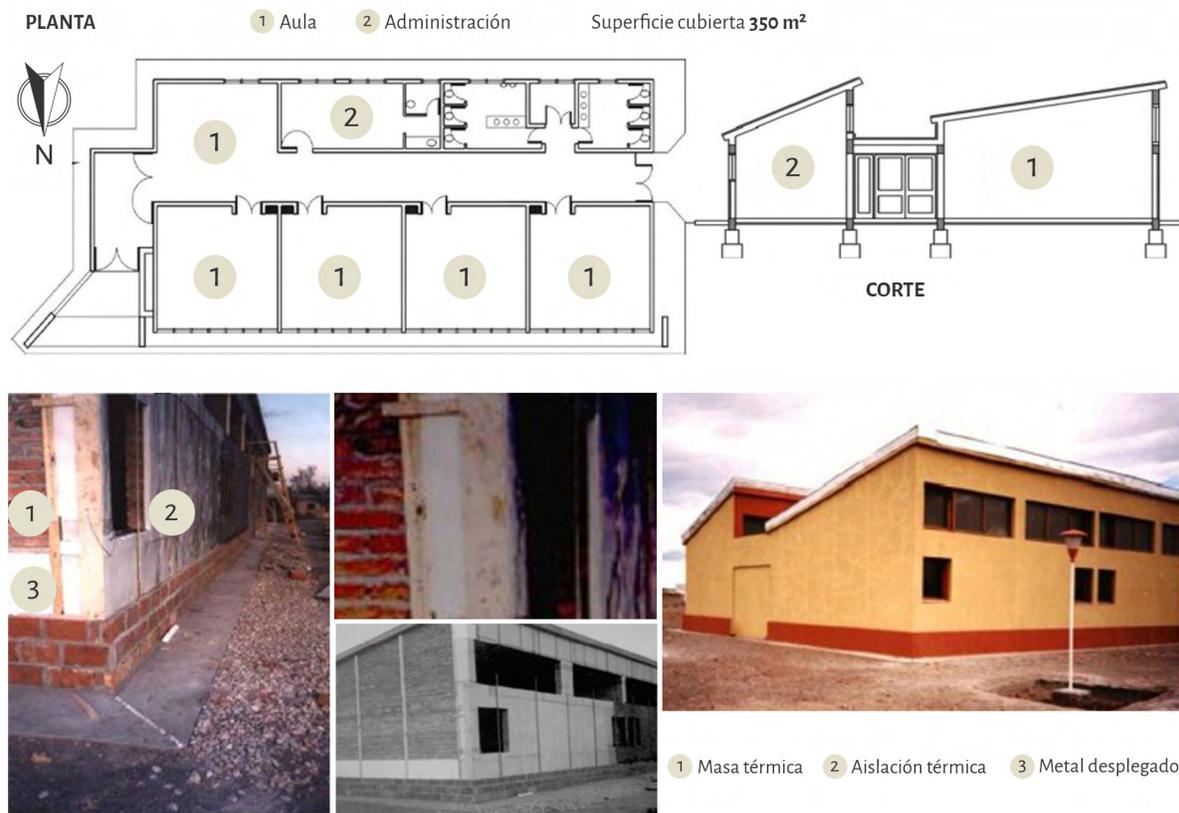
Escuela de Algarrobo del Águila, La Pampa. Ariba: planta del conjunto y corte transversal. Abajo: Fotografías de detalles constructivos y vista norte. Fuente: Filippín, 2021.
